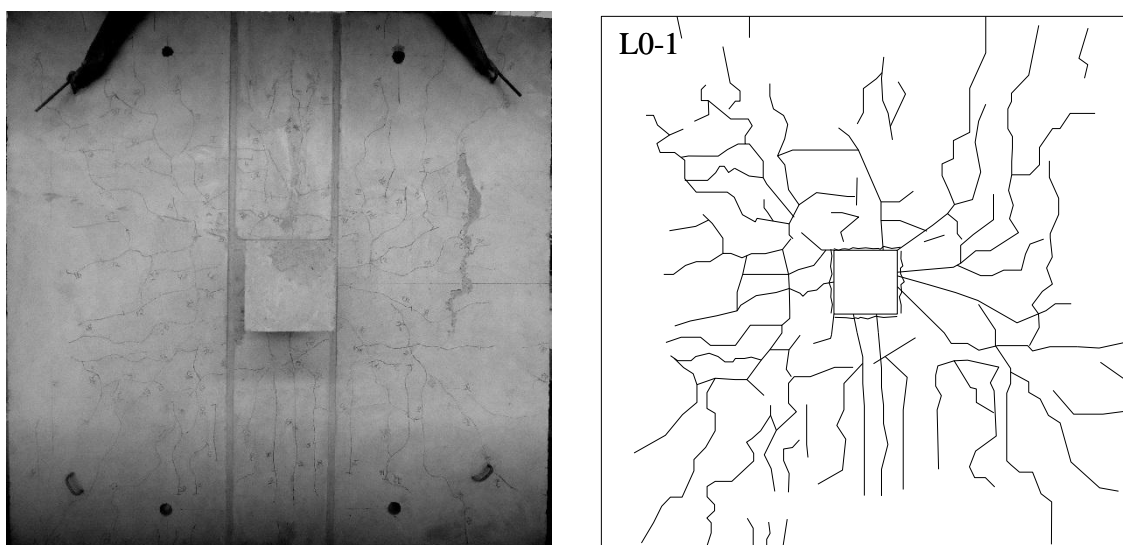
Padrão de Fissuração - L0-1
